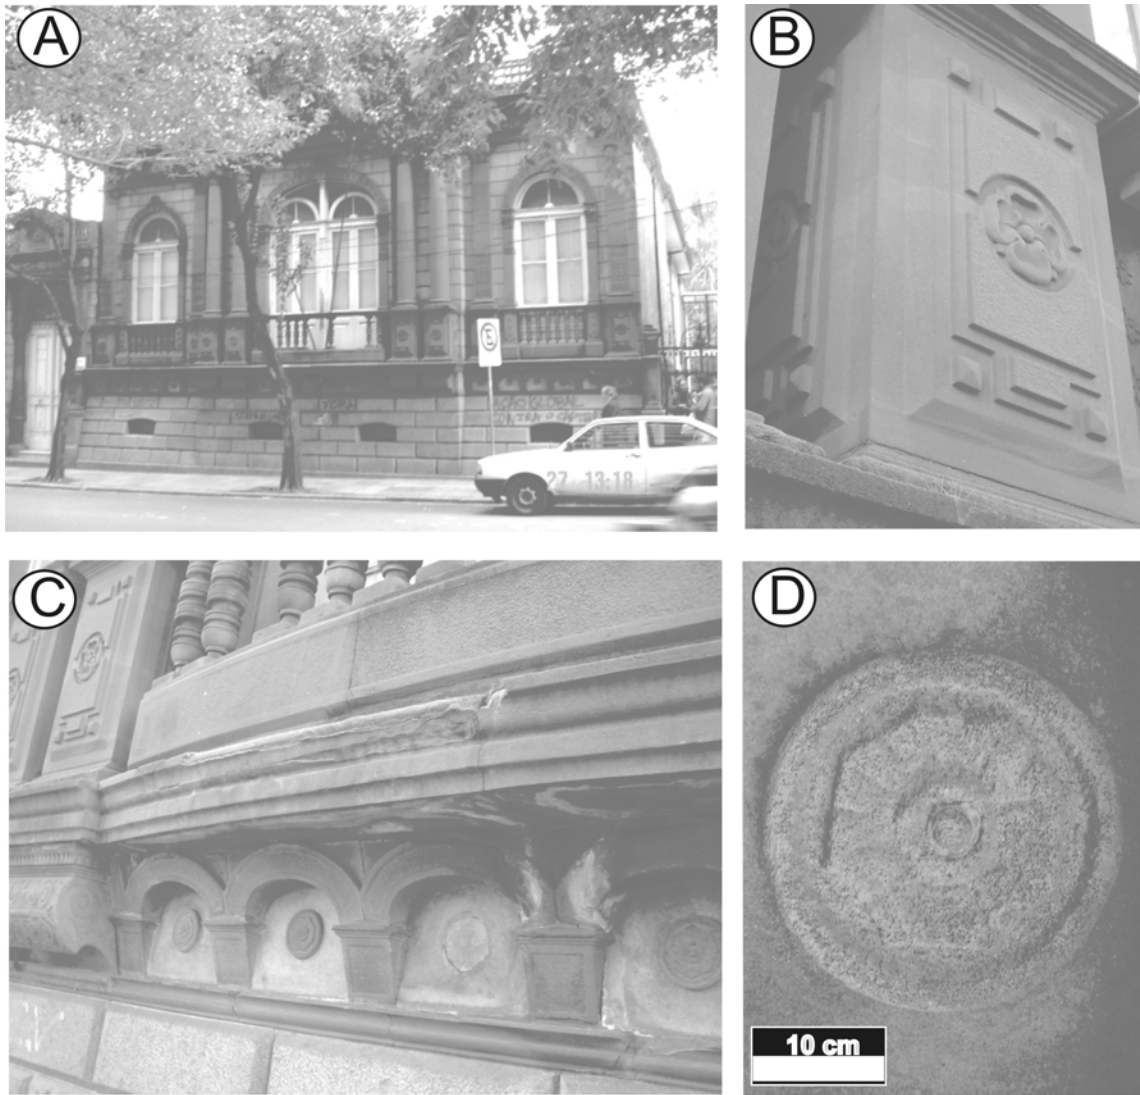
Fotos do Museu Júlio de Castilhos. A. Vista geral da fachada do Museu; B. Detalhe do trabalho de escultura em arenito da fachada do museu; C. Feições de deterioração da fachada do Museu evidenciando a fragmentação e arredondamento de face de bloco de arenito da base da sacada. No canto inferior direito nota-se a deposição de eflorescência salina de cor branca; D. Detalhe da roseta central da figura anterior evidenciando a perda de material por alteração intempérica.
